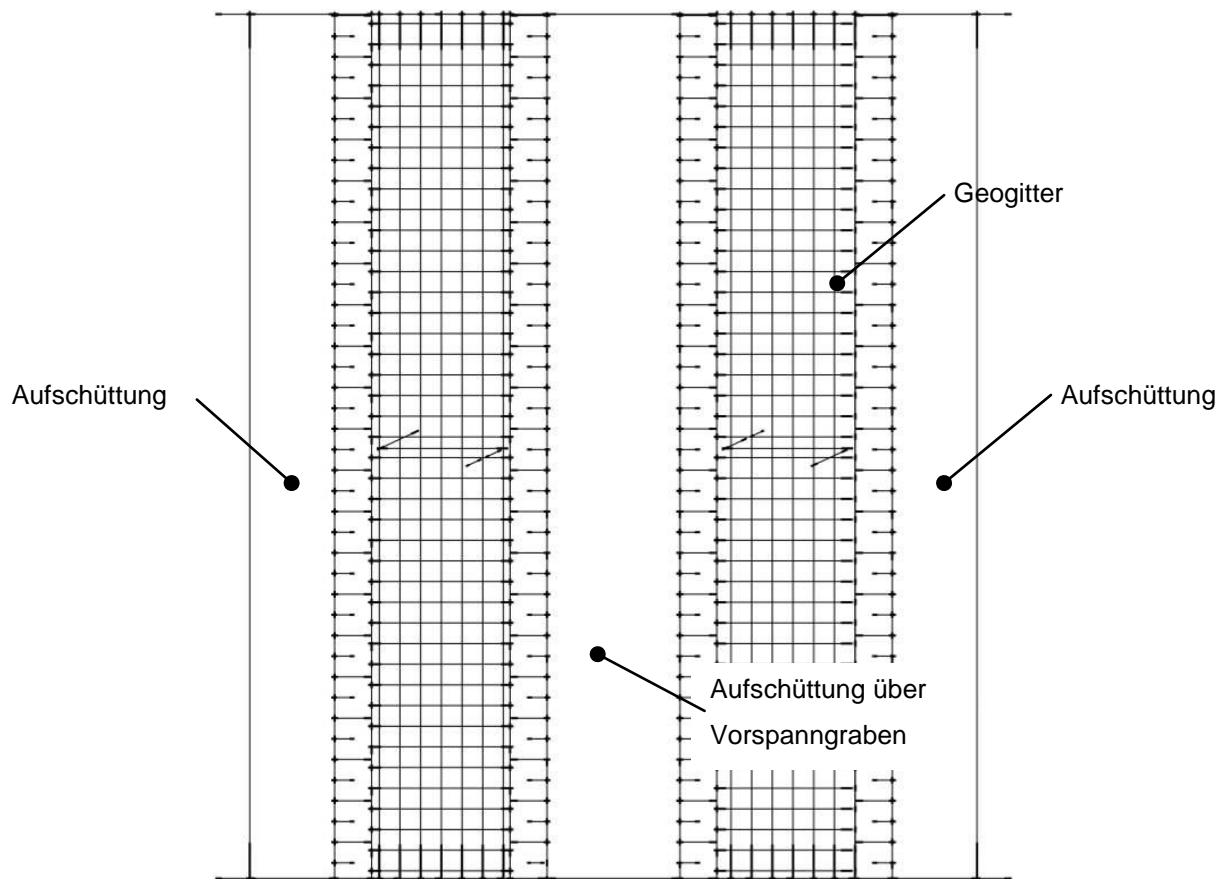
Aufschüttung über Vorspanngraben – Grundriss
